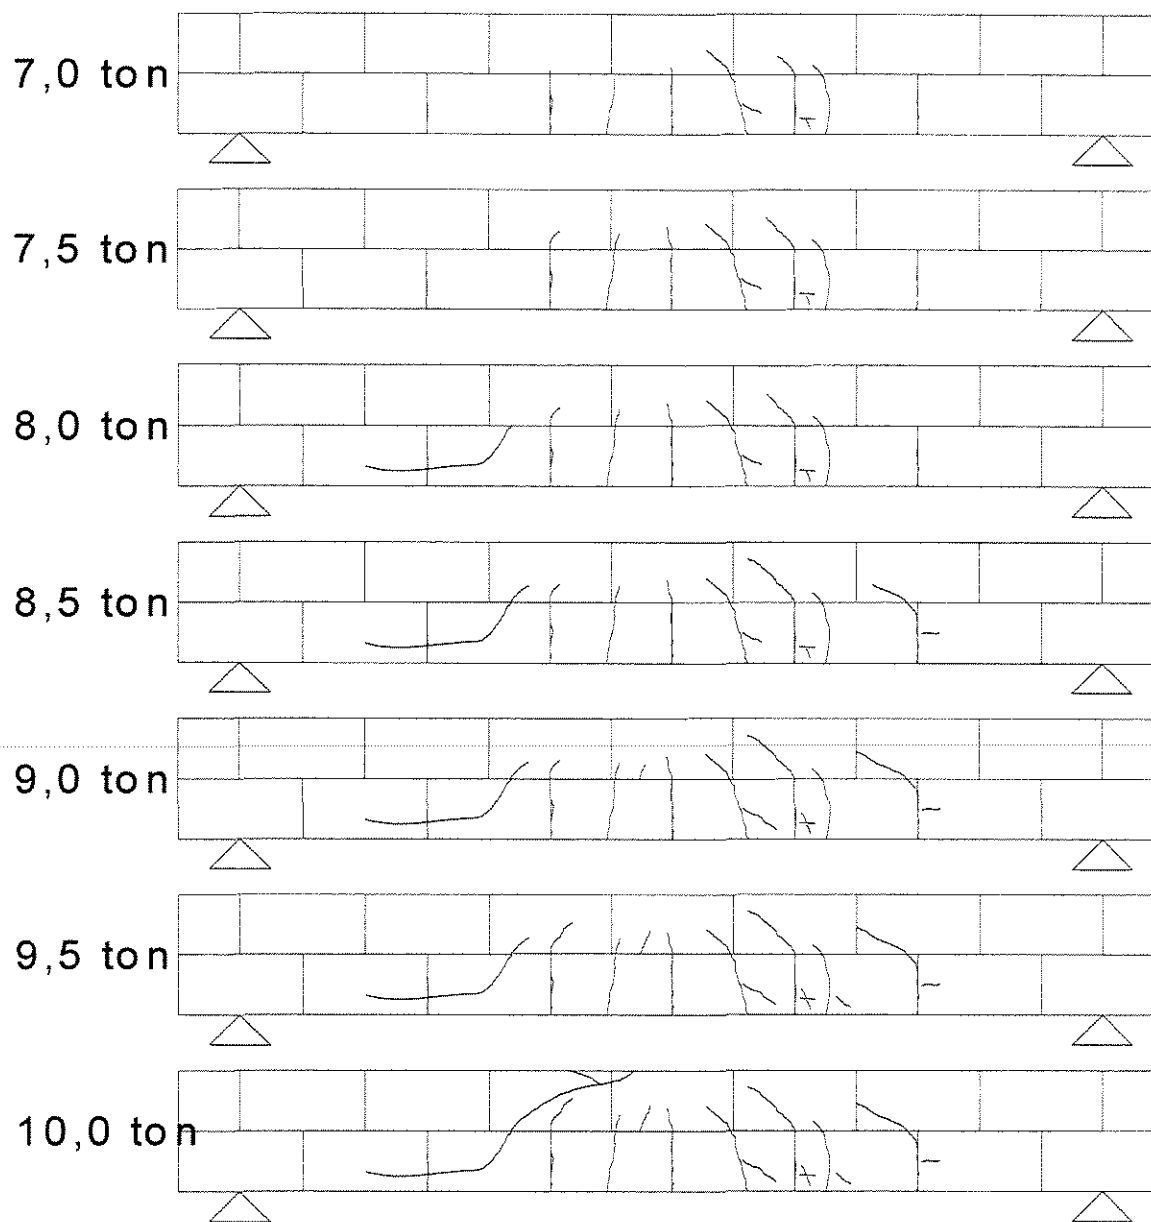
FISSURAS VIGA 2BL-CIS
